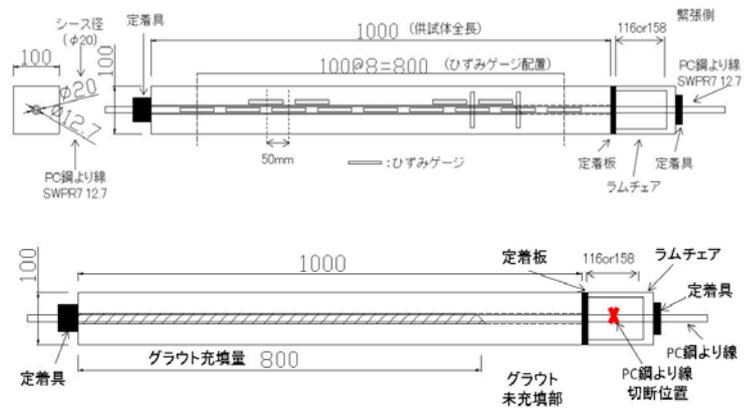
試験体概要およびひずみゲージの配置(単位 mm)
